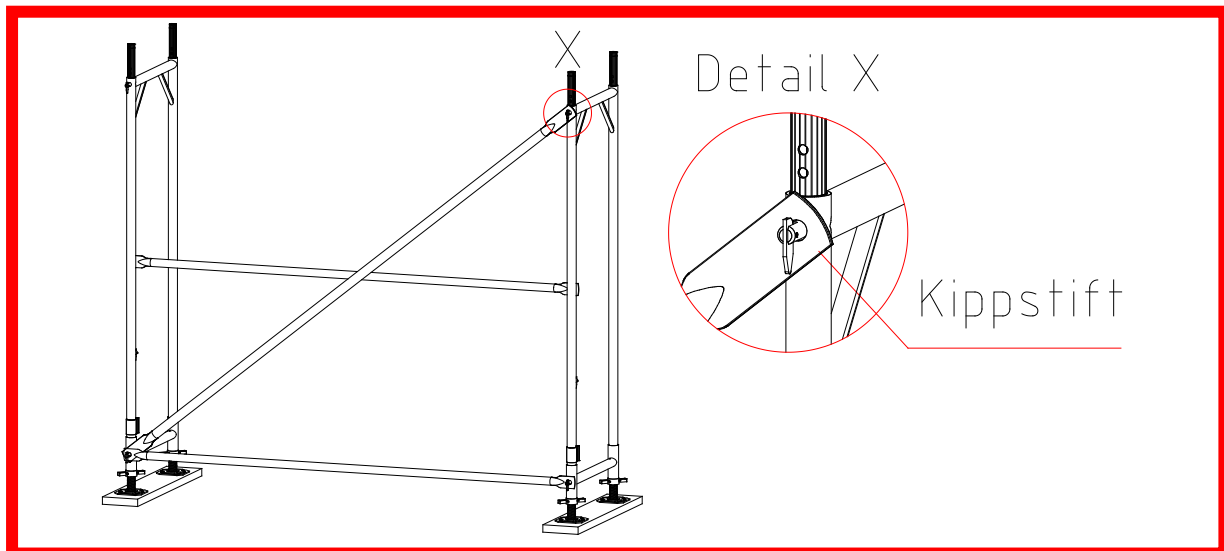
Aufbau des ersten Gerüstfeldes mit Vertikalrahmen 2,0m
